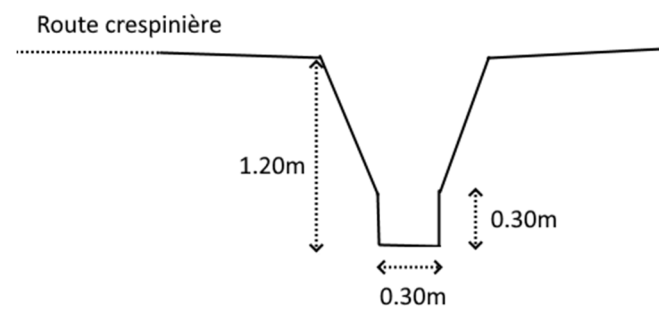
coupe du ruisseau en bordure du bassin de Beausoleil – coupe C
